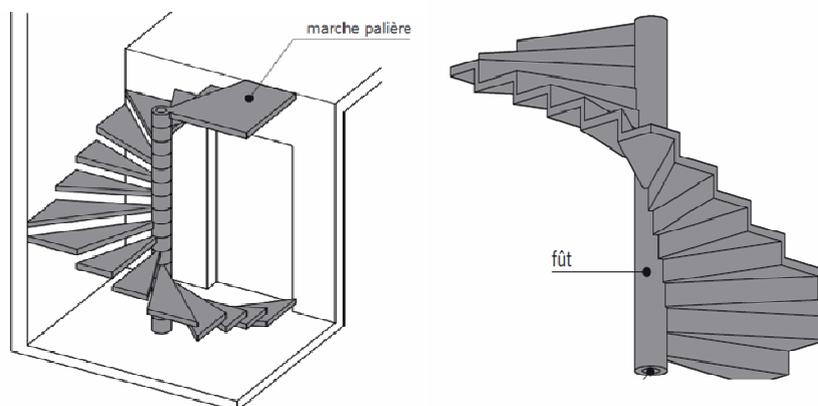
Escaliers hélicoïdal avec marches préfabriquées.
